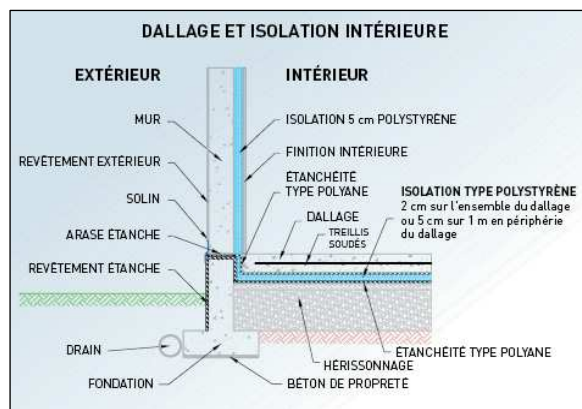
coupe d'isolation dallage sur terre-plein en zone 3 et 4
